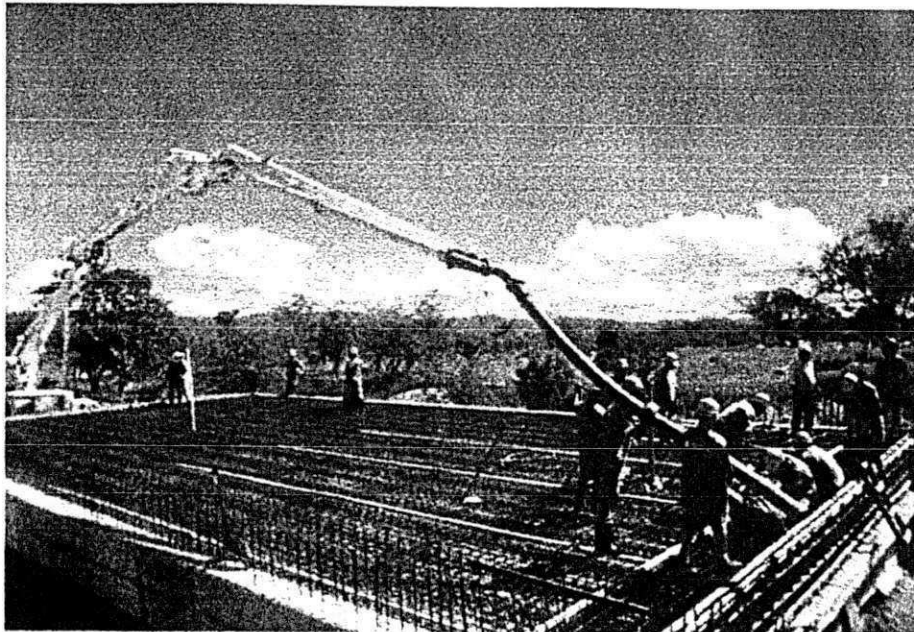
Detalhe da concretagem do Viaduto sobre o Rio bitonho na estaca 2180.
